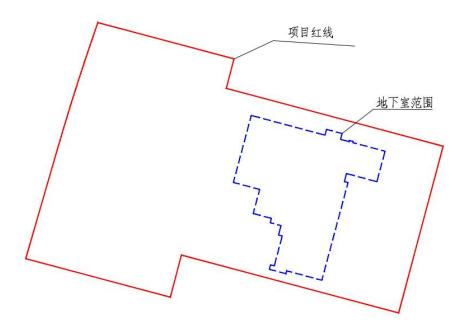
地下室平面图 (红色为用地红线,蓝色为地下室轮廓)
